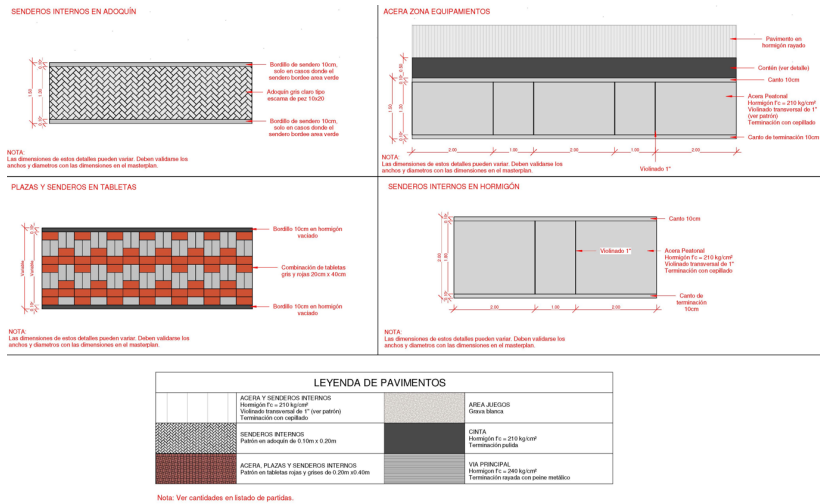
Detalle de pavimentos propuestos en Las Lilas Etapa 01. Fuente: URBE, octubre 2025
